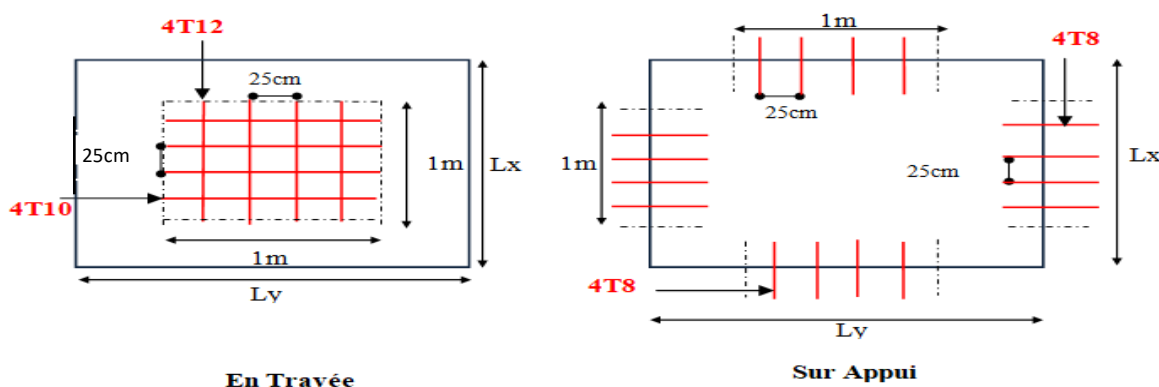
ferrailage du plancher 1^{ère} étage.
